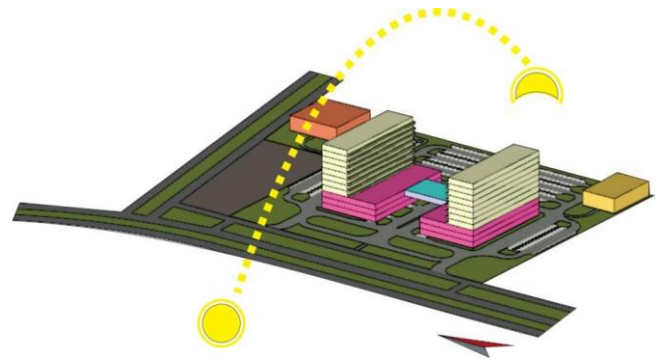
Penataan Tapak dan Siteplan Bangunan
